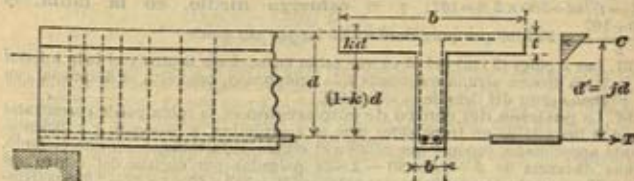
Sección de una viga armada en forma de T simple. Teoría.
